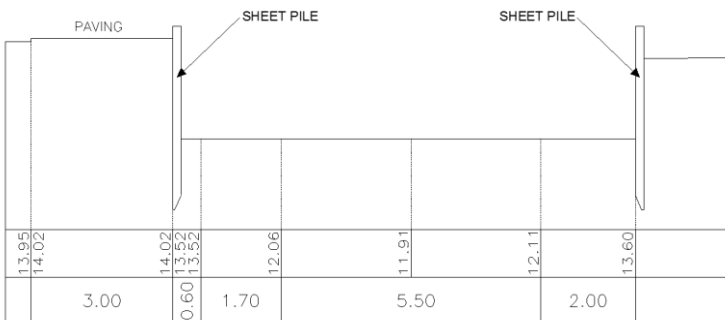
Penampang Memanjang Rencana Normalisasi *Afvoer* Kemambang
